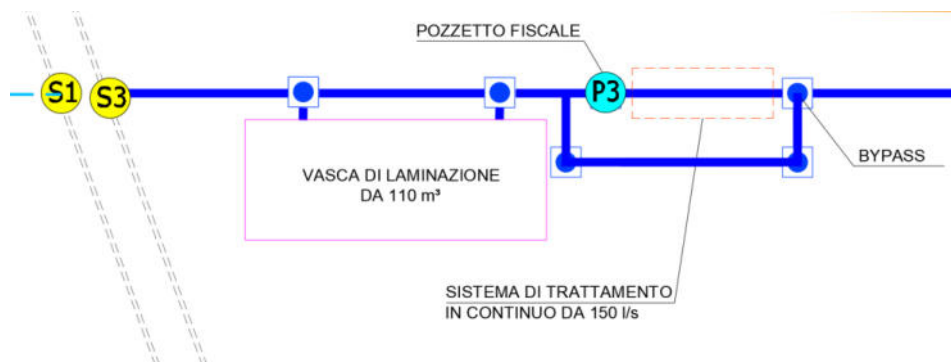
Schema rete acque bianche allo stato di progetto (stralcio).
